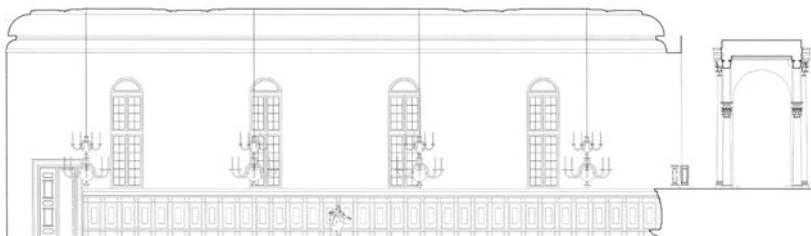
Sezione longitudinale del refettorio e dell'annessa loggia con l'osservatore nella stazione pianificata dal pittore (elaborazione S. Masserano).
